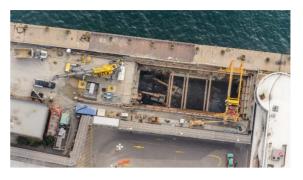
Travaux de construction étanche de tunnel en eau (p. ex. Eglinton et Spadina, Toronto)
